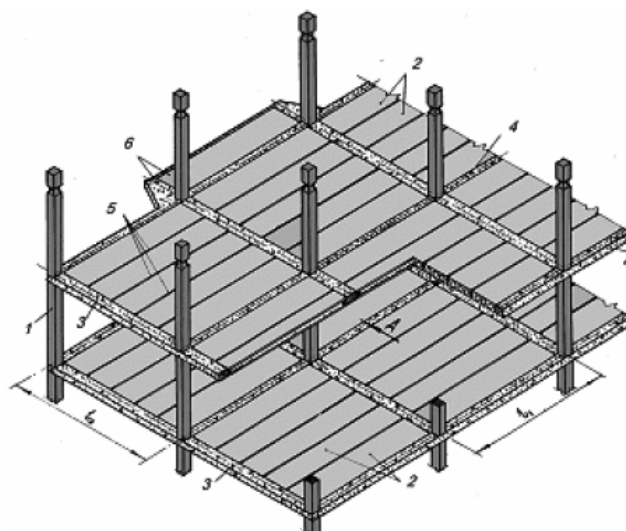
Перекрытия здания. Серия Б1.020.1-7
